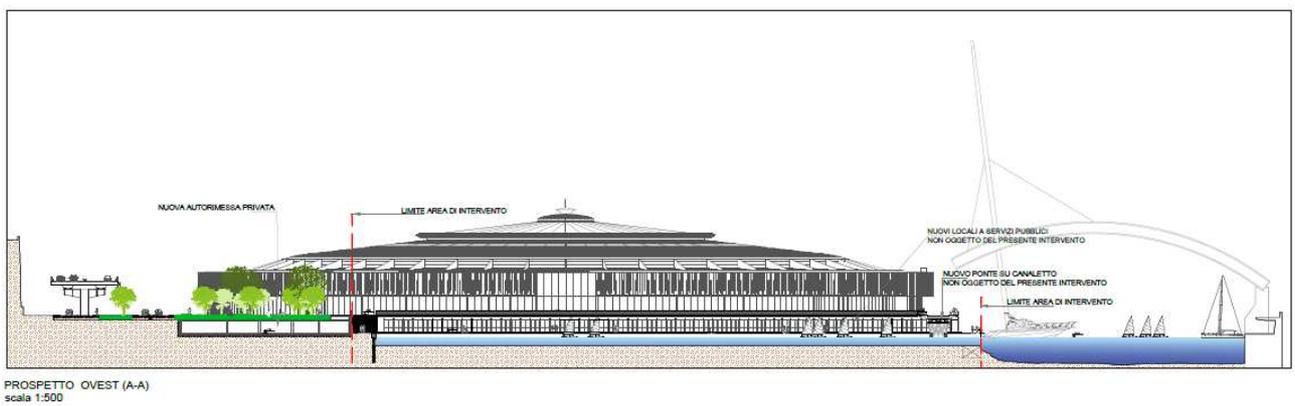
Sezione lungo il Canaletto e prospetto del Palasport (stralcio della tavola T08-D-Ar del Progetto Definitivo).
